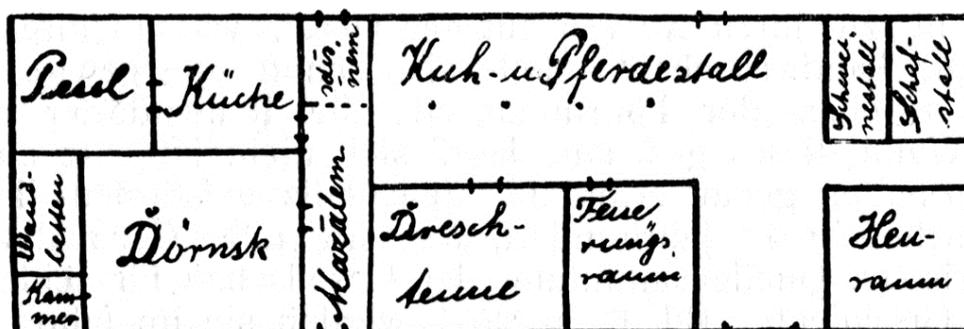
Grundriss eines Hauses von Amrum, Baujahr 1675
